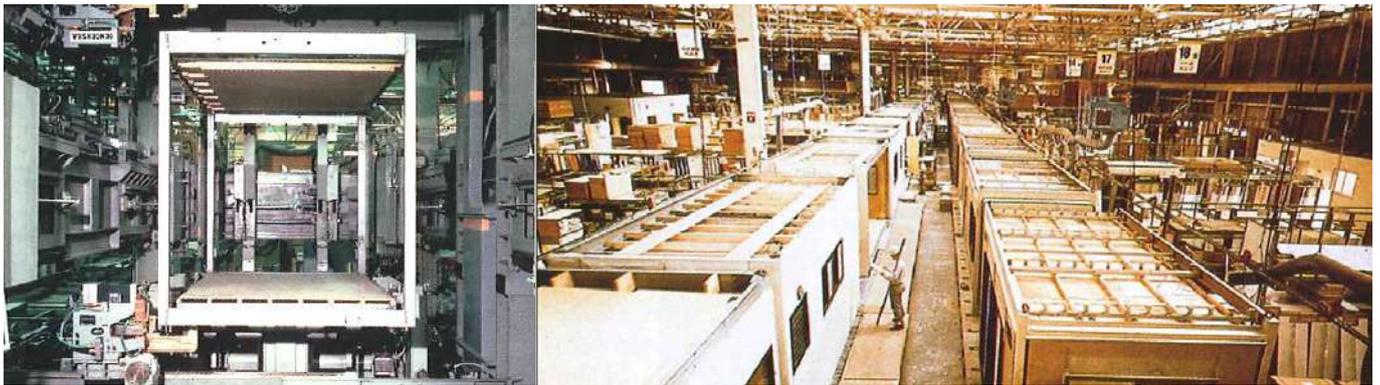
Planta de producción de la empresa japonesa Sekisui (SCI P-272).
